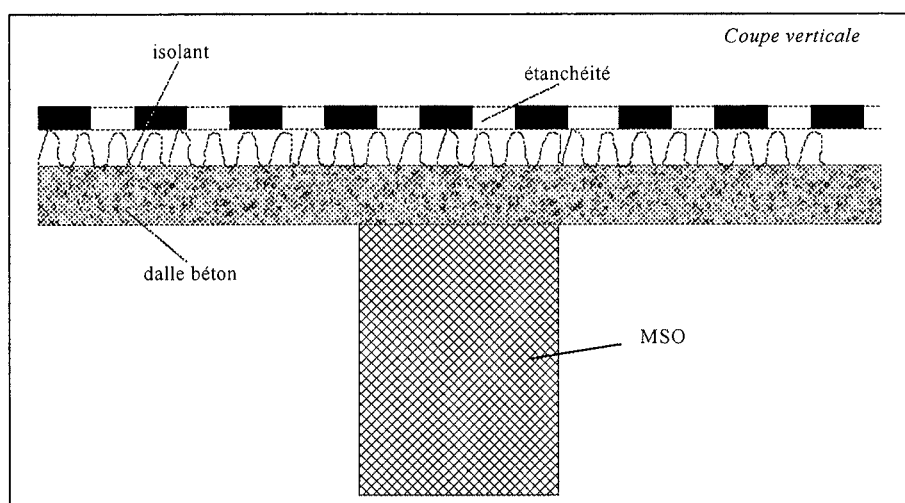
a : Cas d'une toiture-terrasse en béton armé : coupure de la toiture non nécessaire
